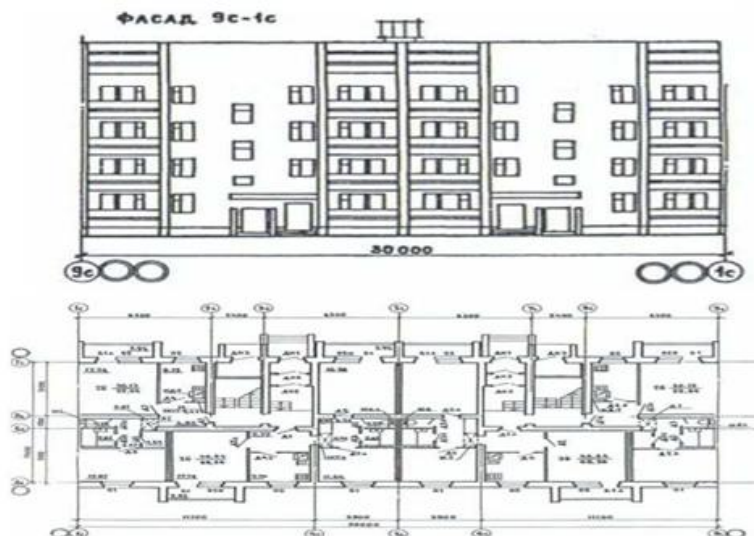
Фасады и план жилого здания серии 86-04.01.86 второго индустриального периода домостроения
